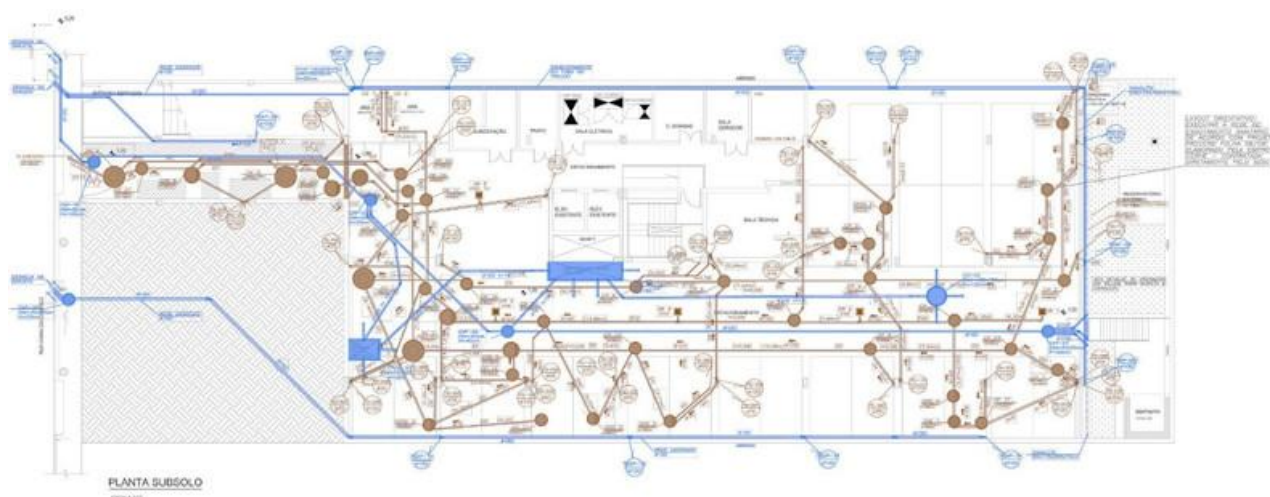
Planta Subsolo – redes de tubulações de esgoto (marrom) e drenagem (azul).
